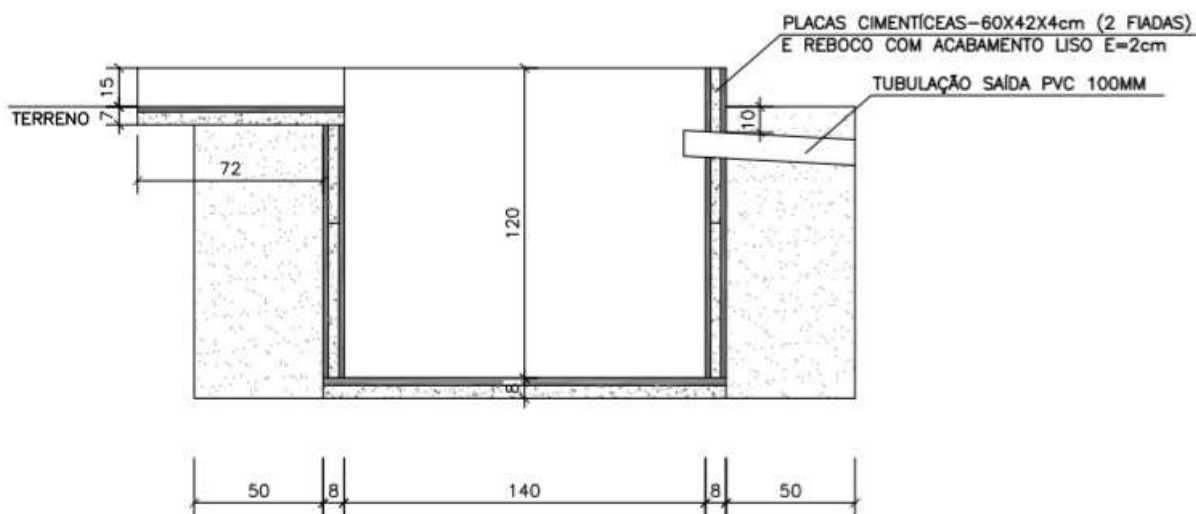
Caixa de Sedimentação com canaleta de entrada – Corte A-A'
